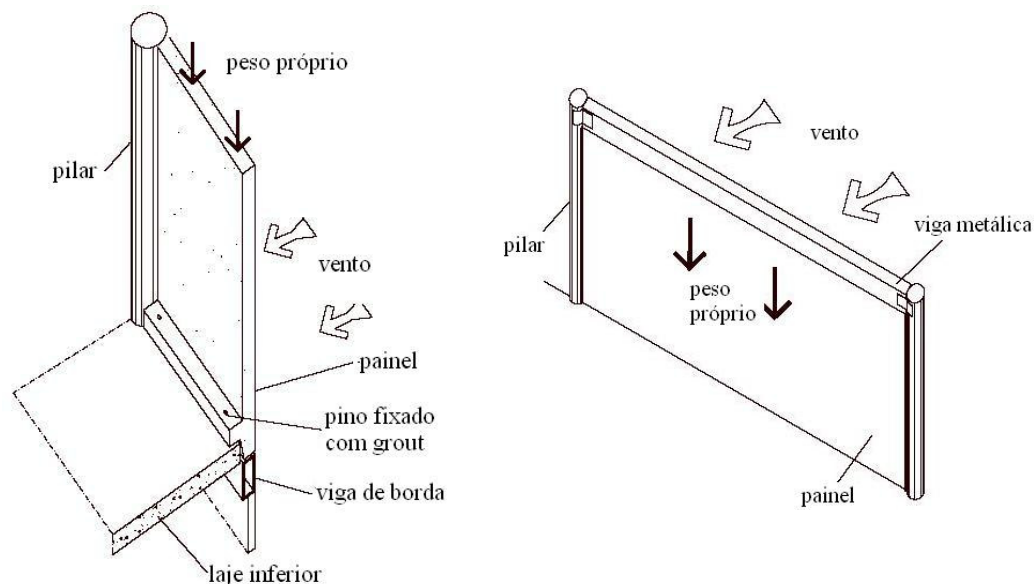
Esquemas de fixação de painel de concreto em laje e viga de borda e em pilares
